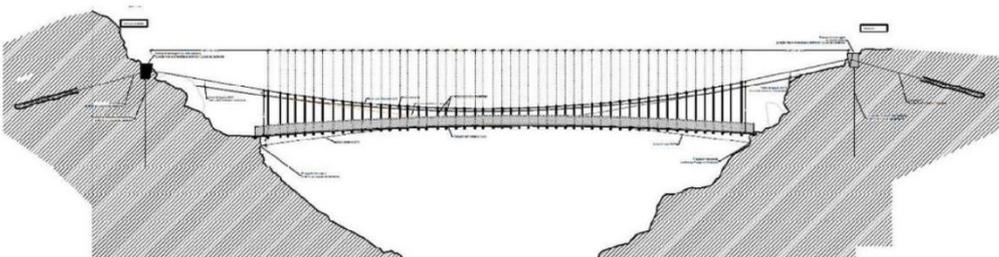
Alçado da ponte após intervenção (sem escala)
